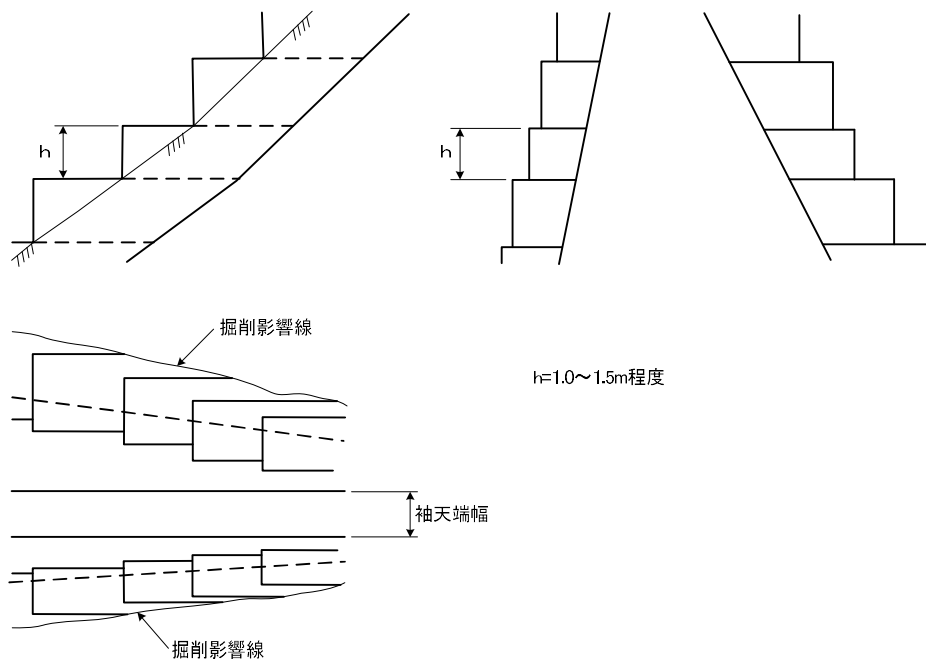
間詰め設計(間詰めコンクリートが階段状の場合)
